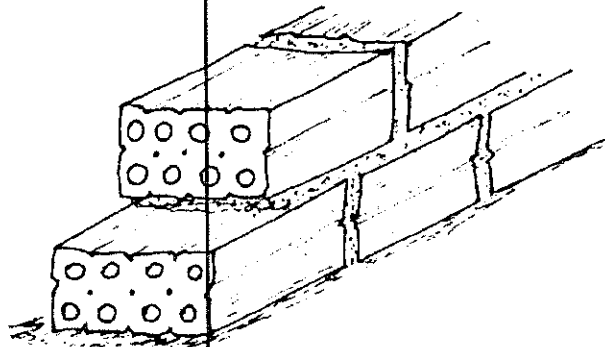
Execução de alvenaria de 1 vez, utilizando tijolos furados.
